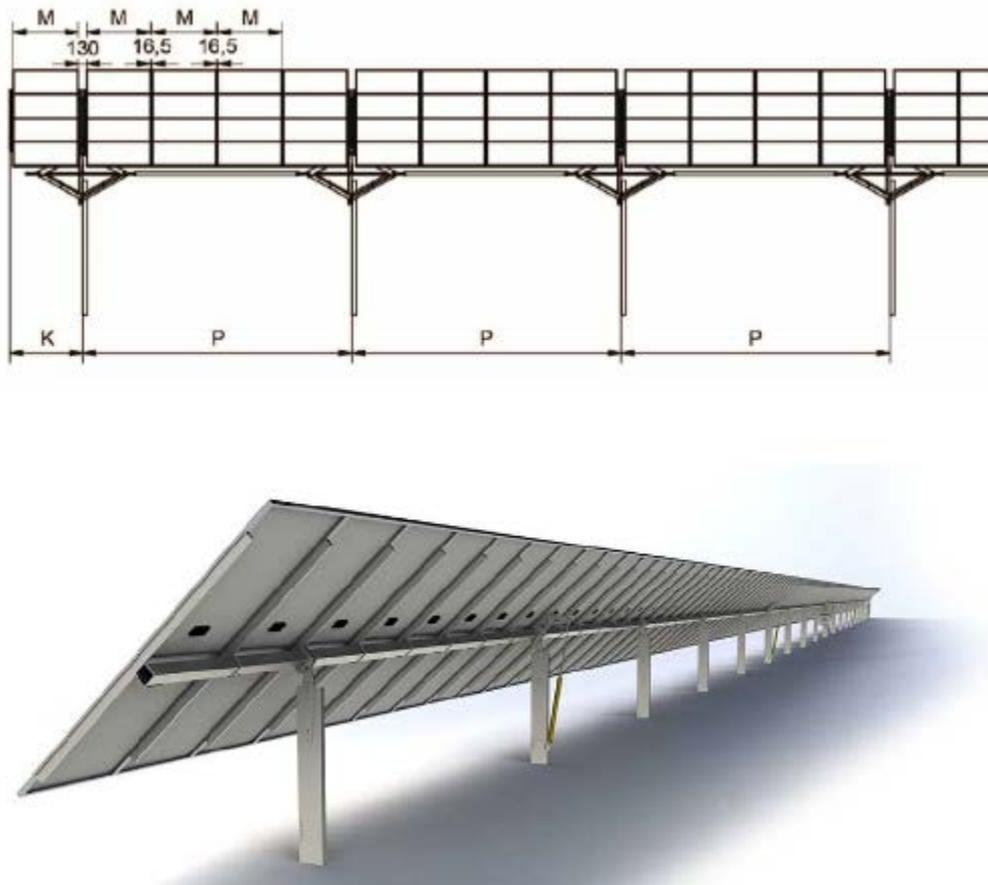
Prospetto della struttura di sostegno dei moduli su tracker.
